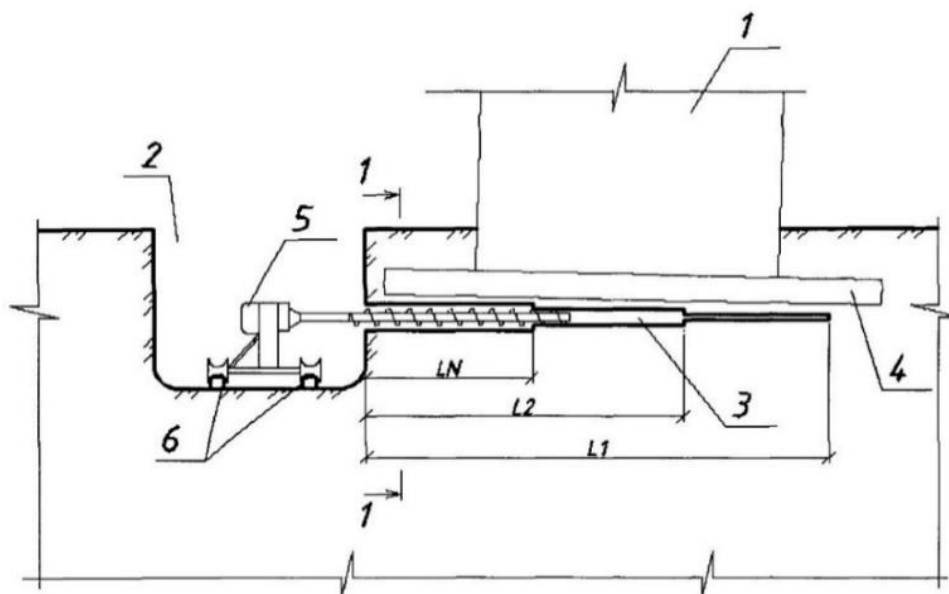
Бурение горизонтальной скважины: 1 – здание; 2 – котлован; 3 – скважина; 4 – фундамент; 5 – буровая установка; 6 – рельсы
